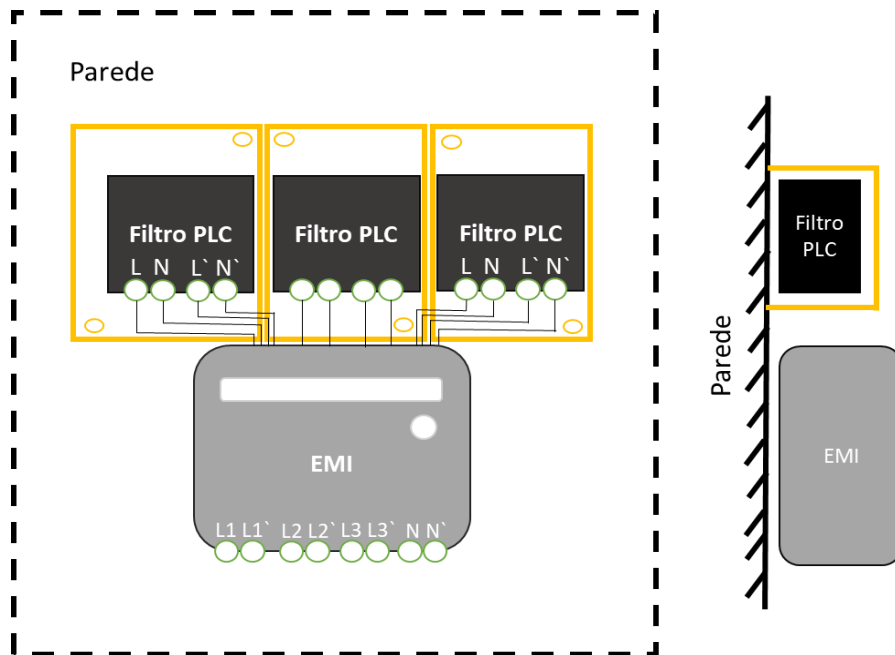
À direita vista frontal de uma instalação de Filtro(s) PLC protegida por caixa individual, e à esquerda vista lateral da instalação;
